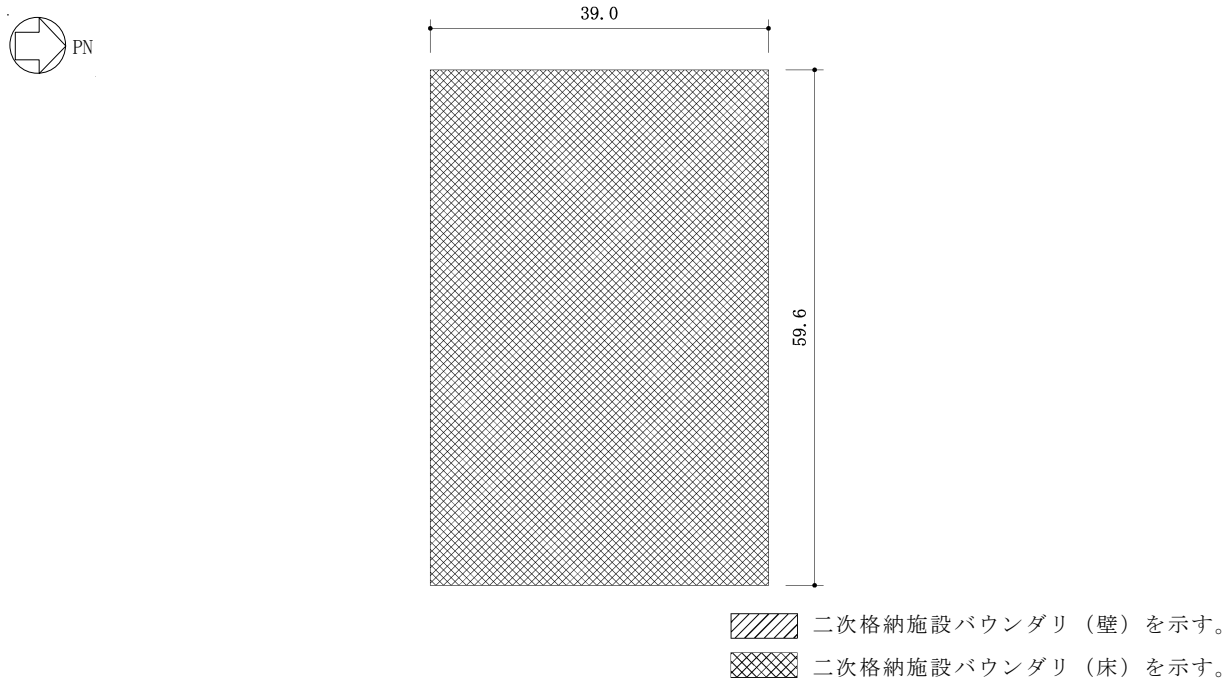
原子炉建屋原子炉区域（二次格納施設）の範囲の平面図
